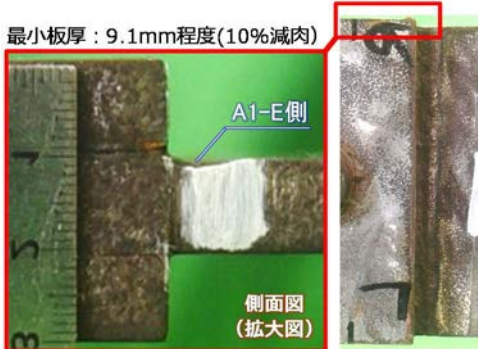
連結板際部の腐食状況（Weld Pass2-2）
